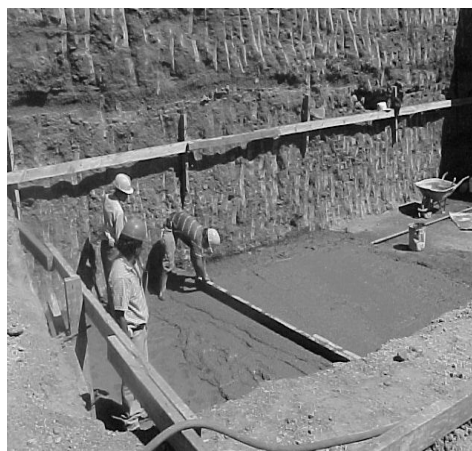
c Losa de cimentación, Puente Amapolita, La Unión.
